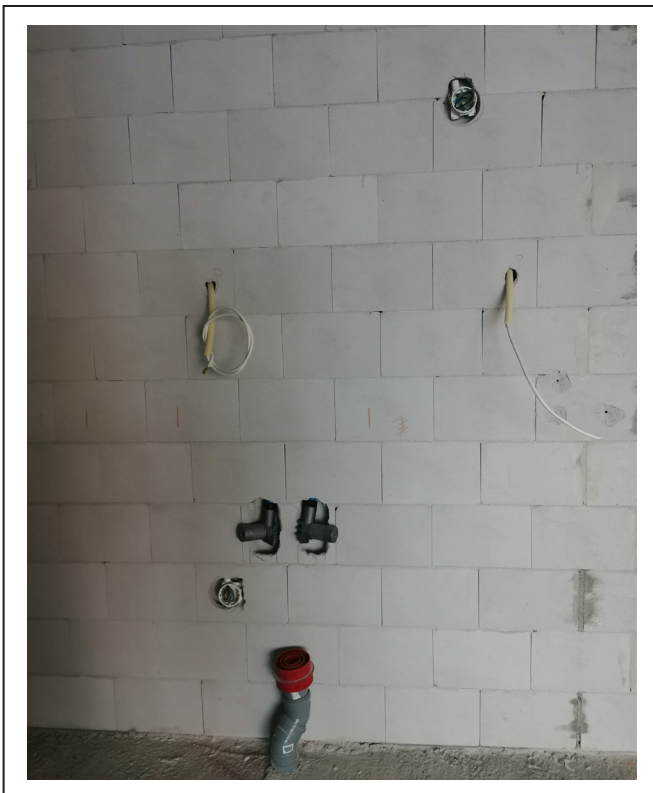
Tässä kohteessa keittiön veden ja viemärin liitännäspisteet tulevat kantavan elementtiseinän puolelle. Samalle seinälle tulevat myös liesi ja liesituuletin. Näin ollen väliseinä, joka erottaa keittiön viereisestä tilasta, on tarvittaessa purettavissa. Jos nämä liitännäspisteet sijaitsisivat tilat jakavan väliseinän puolella, keittiö olisi käännettävissä seinän toiselle puolelle, mutta silloin väliseinän purkaminen olisi vaikeampaa. Kuva: Aki Kortetmäki.
